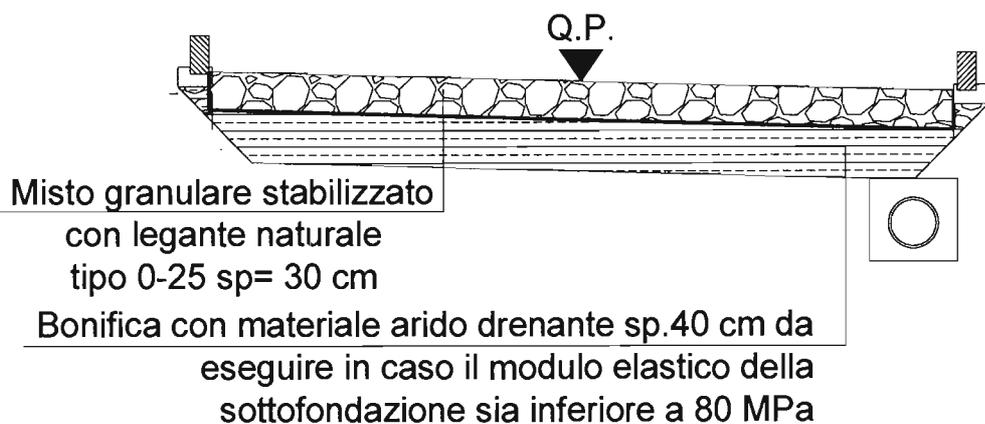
Pavimentazione per Strada di Cantiere Fase Esecutiva Strutture
